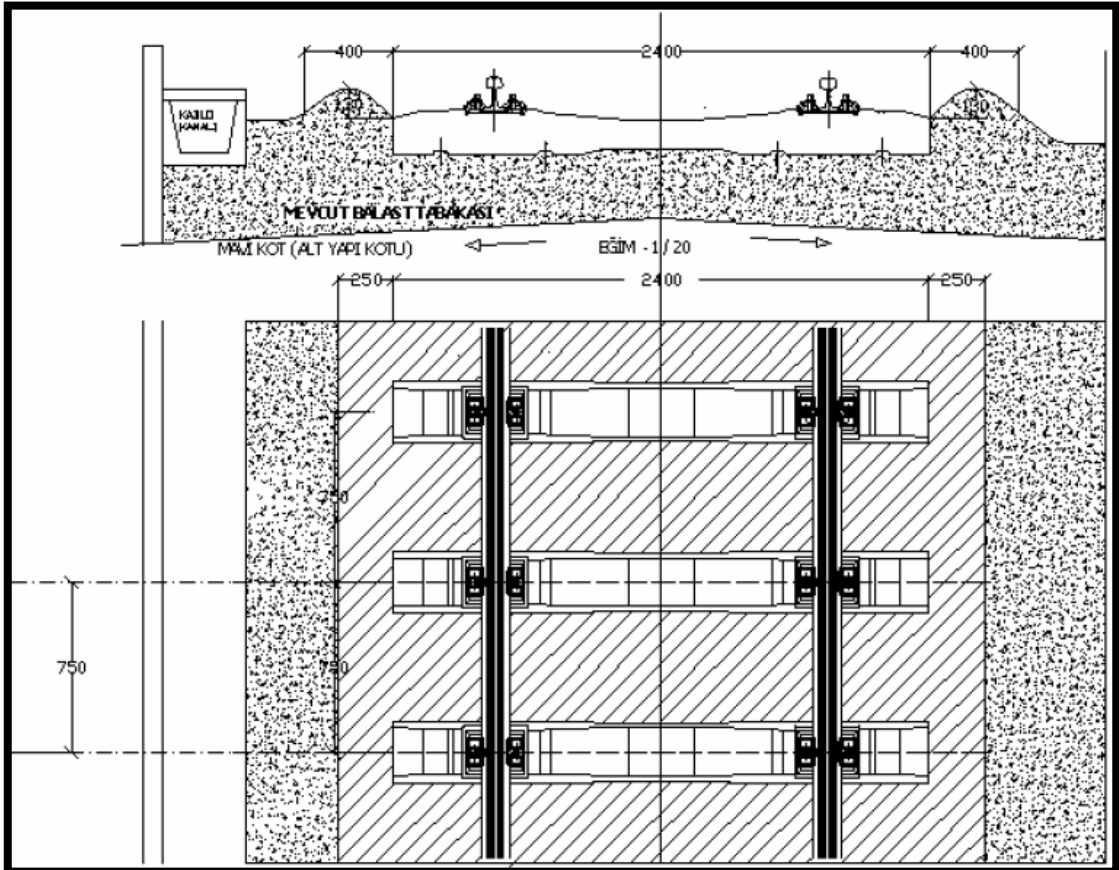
Stedef V.S.B Sistem - Beton Travers Üzerindeki Ray Montajı
